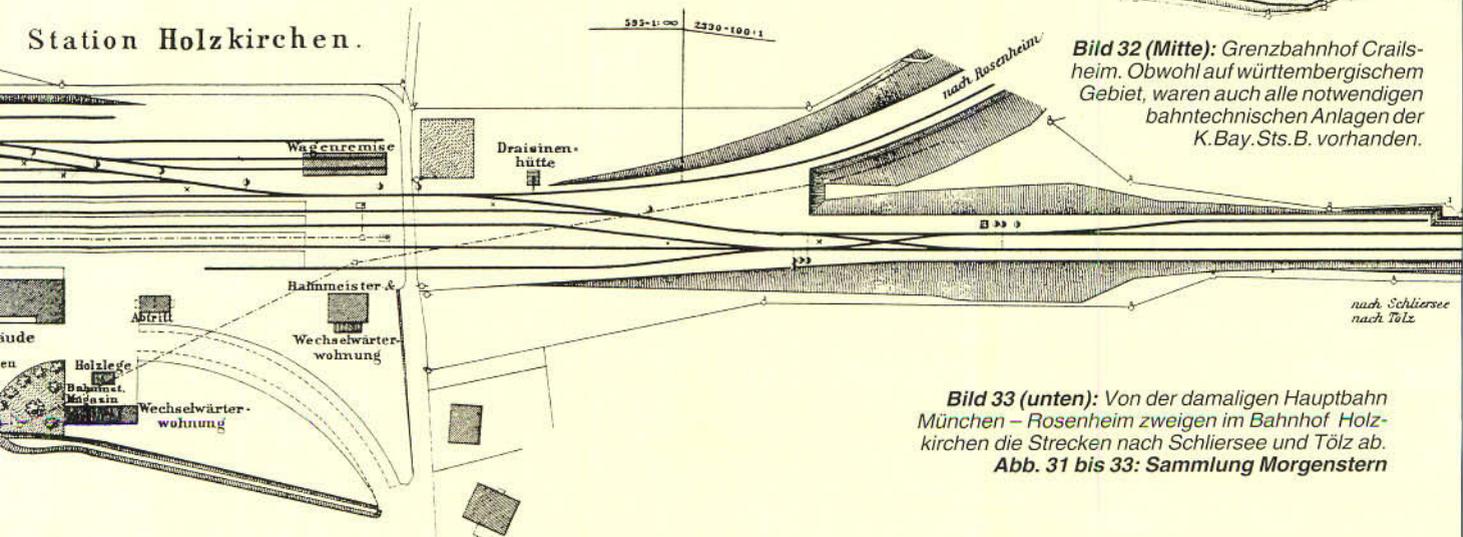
(unten): Von der damaligen Hauptbahn München - Rosenheim zweigen im Bahnhof Holzkirchen die Strecken nach Schliersee und Tölz ab.
